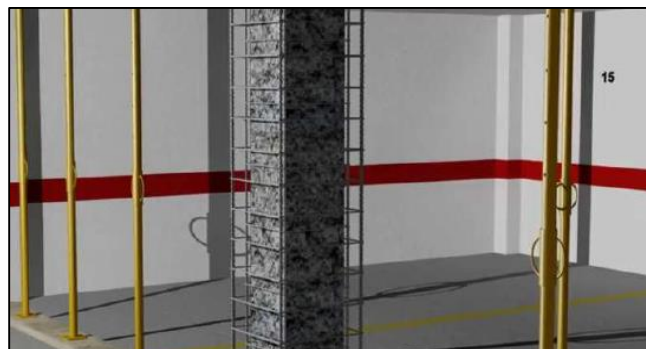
Refuerzo perimetral a columnas existente a realizar - 2
